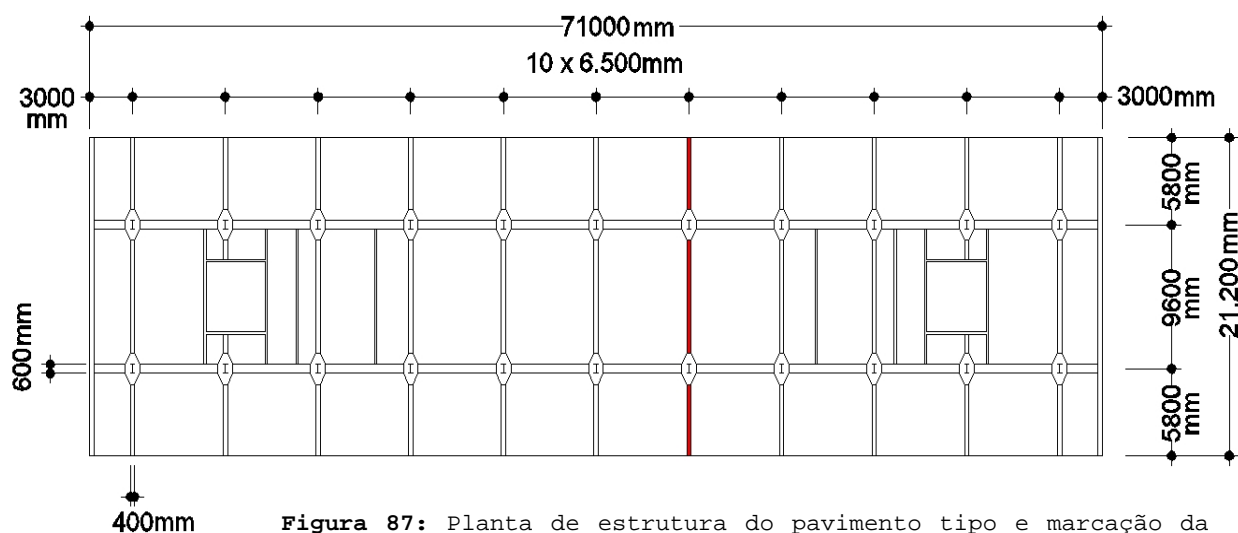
Planta de estrutura do pavimento tipo e marcação da viga, objeto do estudo (em vermelho).
